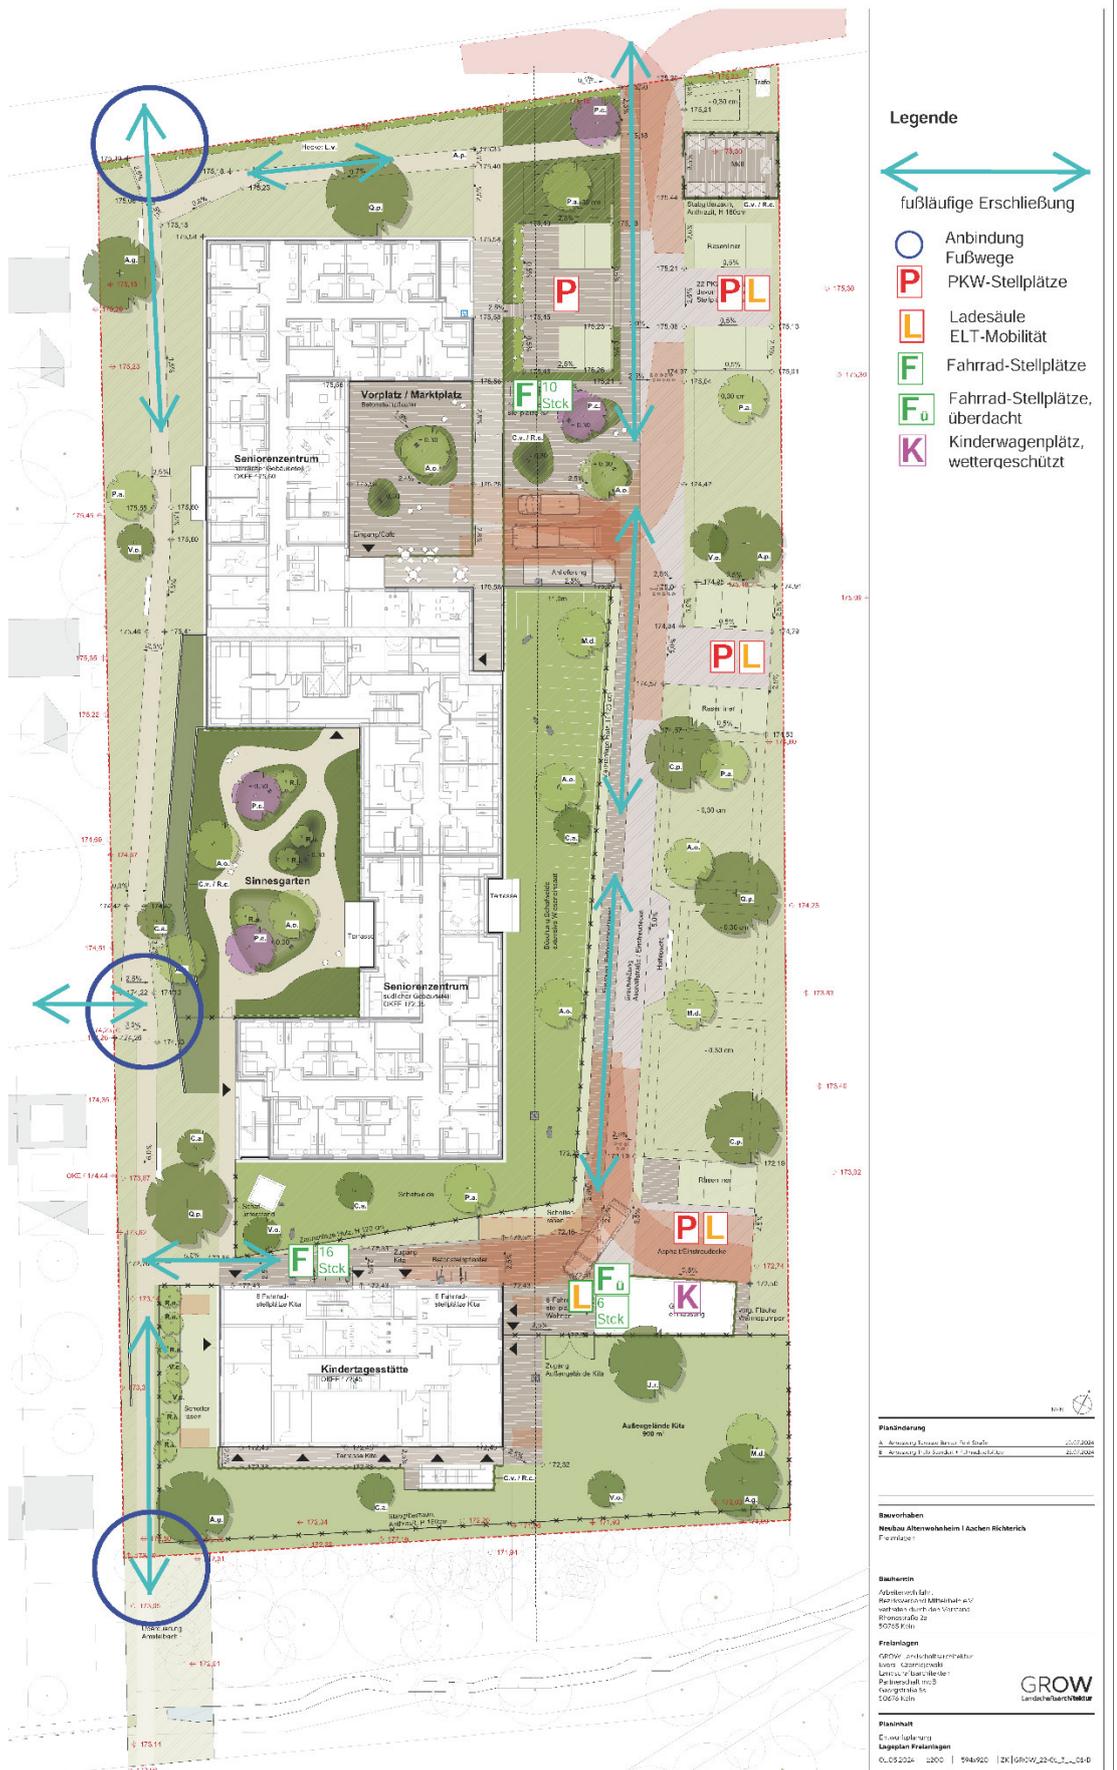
Fußwegführung und Marktplatz, Ausschnitt Lageplan GROW
